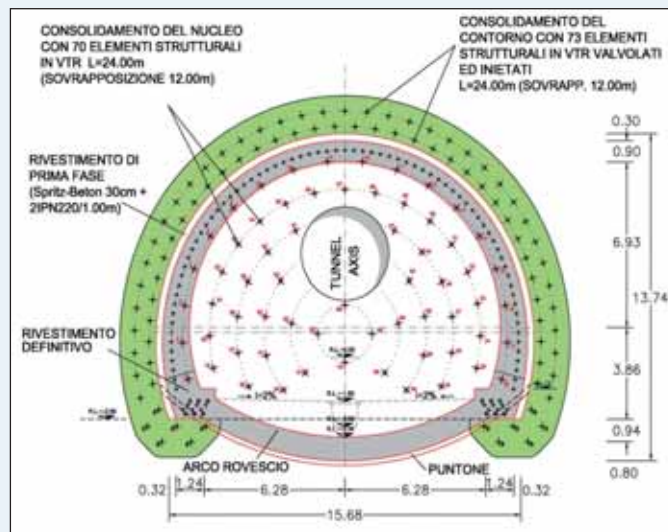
e 10 - La sezione tipo C2 (9) e la sezione tipo B0 (10) (fase di terapia)
